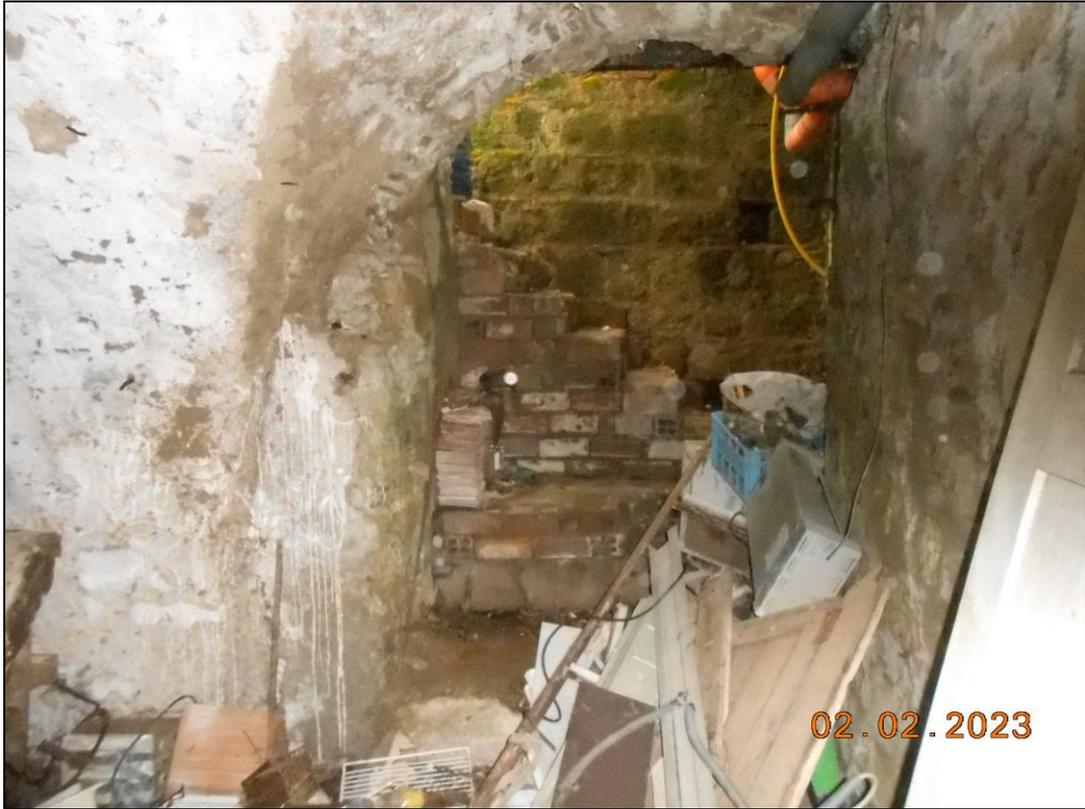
Vista interna del piano interrato dell'immobile pignorato.
